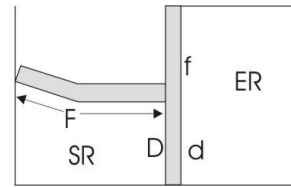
Flanke mit nicht rechtwinkliger Ecke
